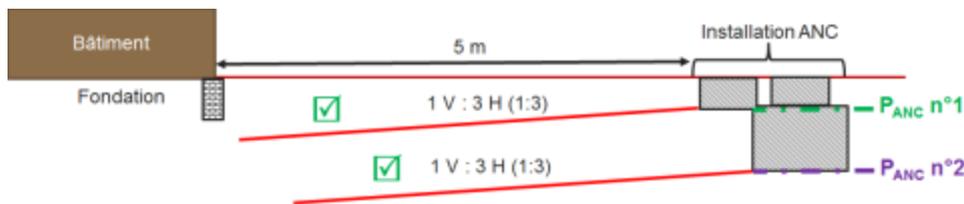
Distance dispositif d'ANC vis-à-vis des fondations – impact hydraulique (vue en coupe).
